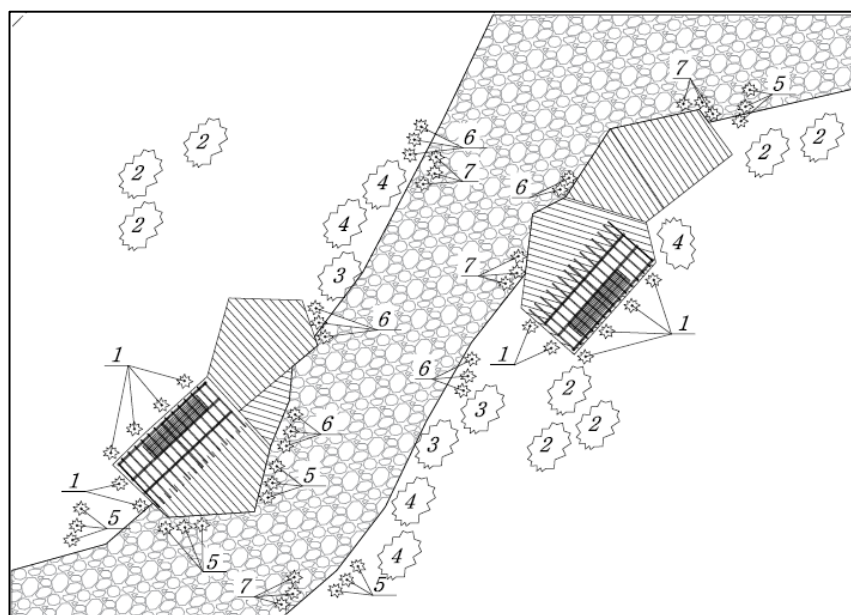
Фрагмент генплана 7, схема посадки растений для зоны «сухого ручья»
